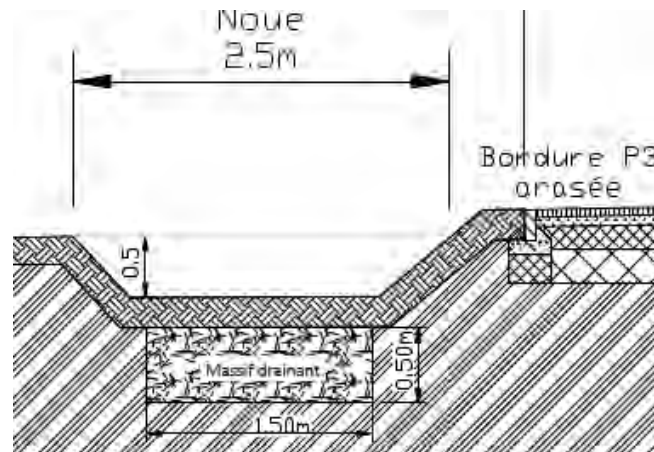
Coupe au droit de la noue et la tranchée drainante du BV 2 (Source : SODEREF)
